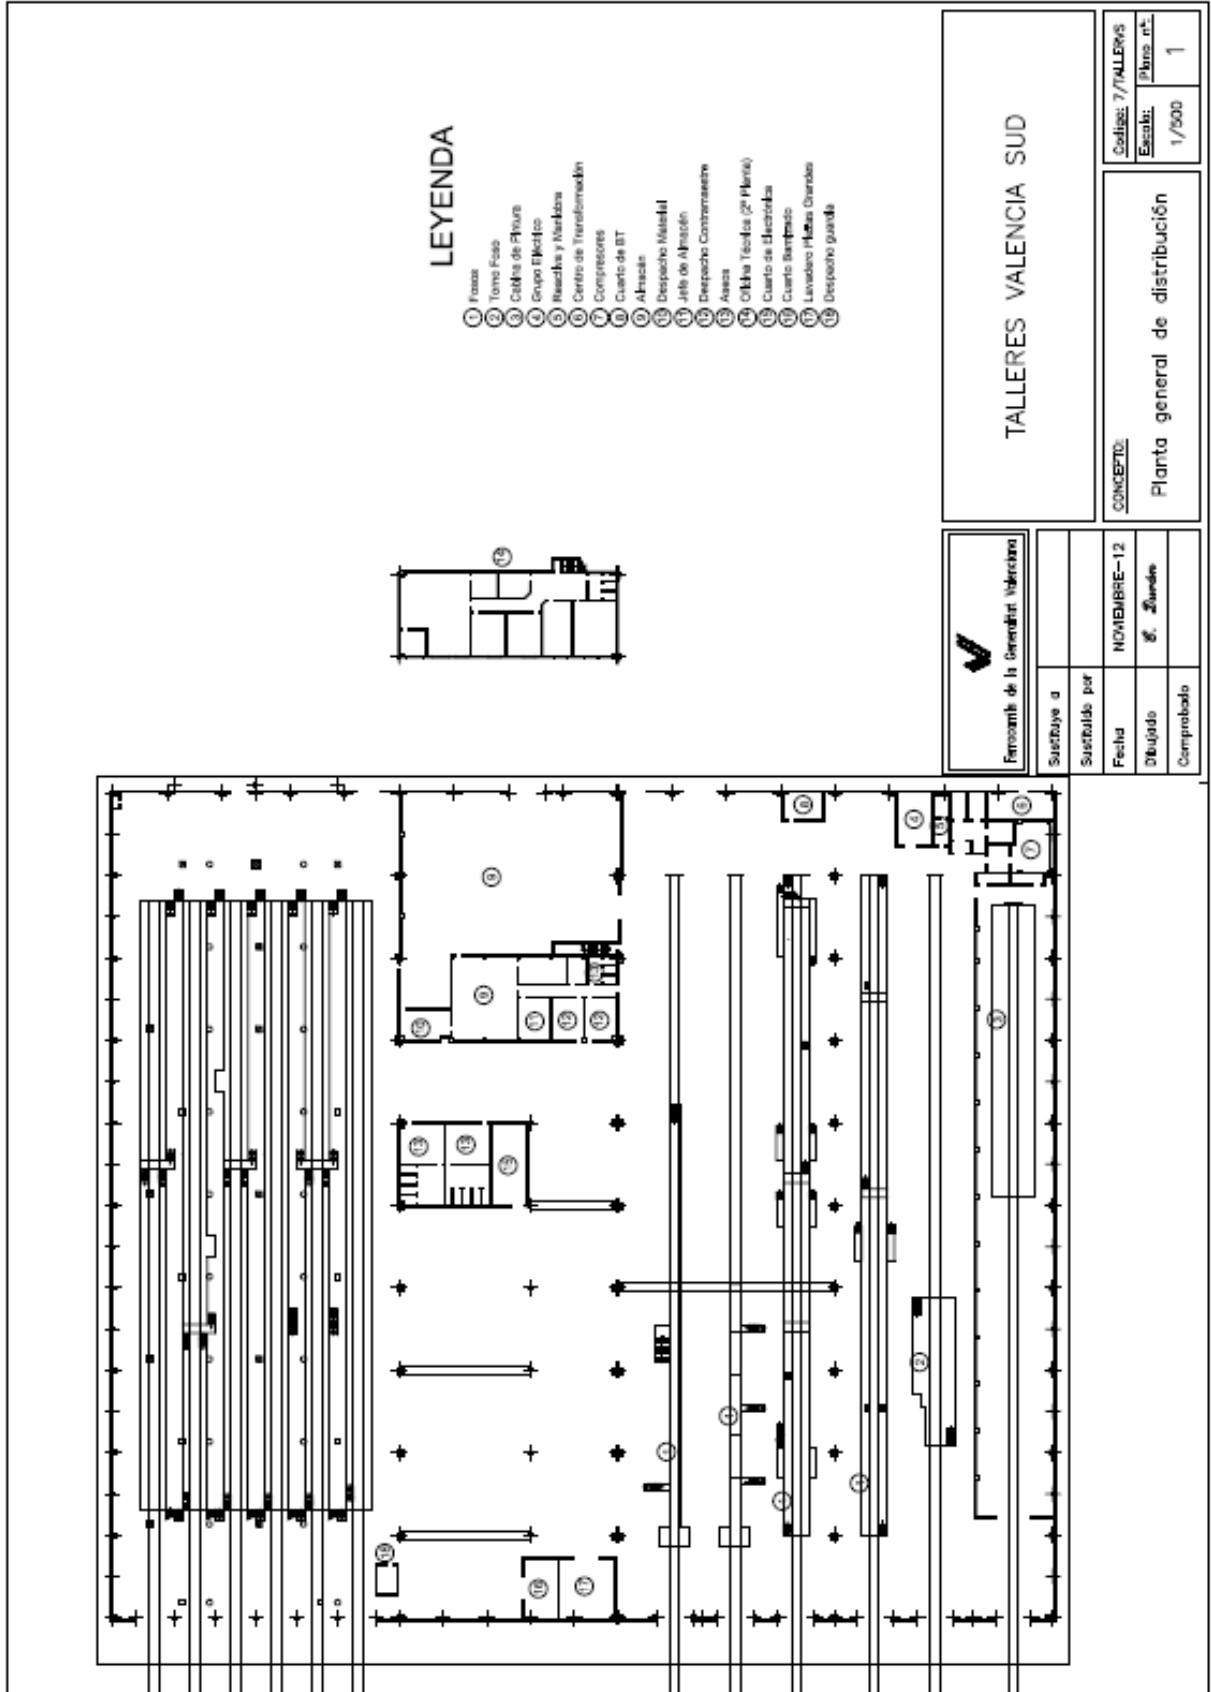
Plano en planta distribución Taller Mantenimiento Valencia Sud. Fuente: FGV.
